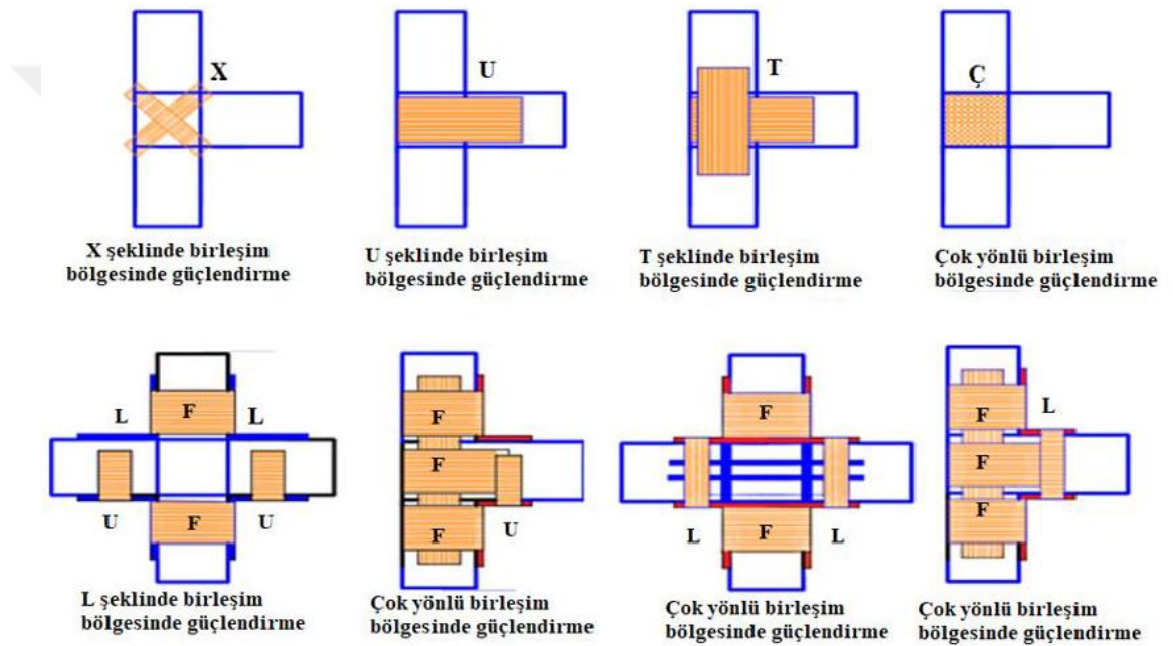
Betonarme kolonlarda FRP uygulama şekilleri (Maraş, 2021)
